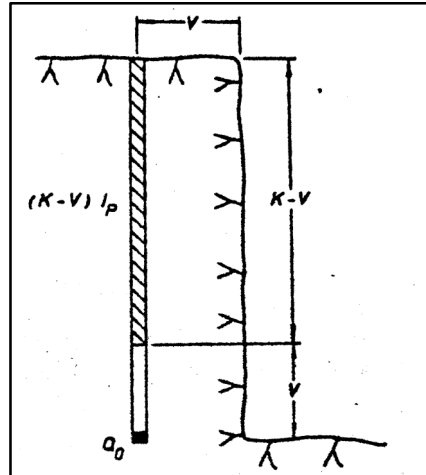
Barreno con carga de fondo concentrada y carga de columna distribuida.
